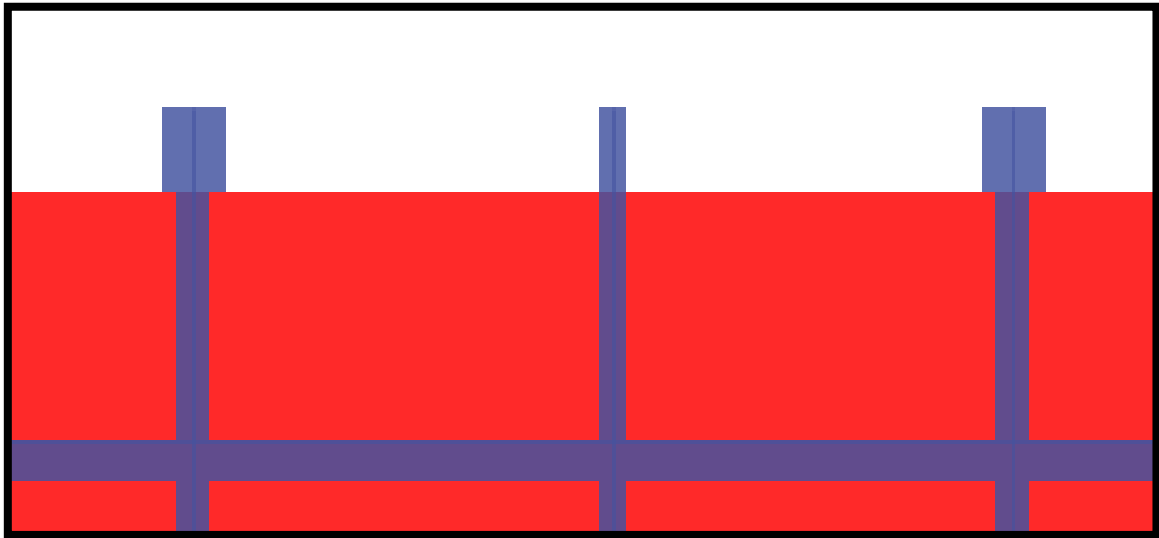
Vista en elevación del reforzamiento de las columnas en ETABS
